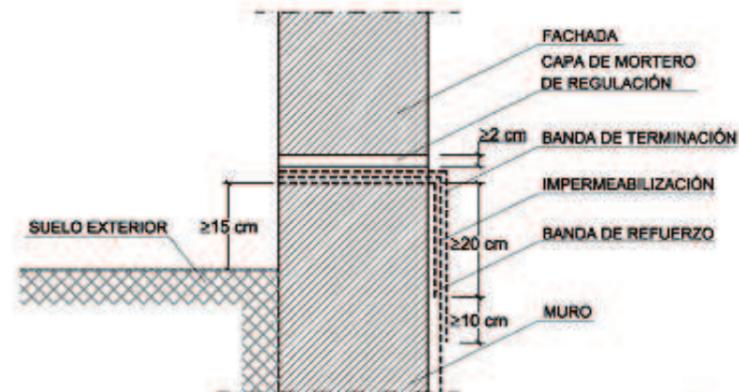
Ejemplo de encuentro de un muro impermeabilizado por el interior con lámina con una fachada
